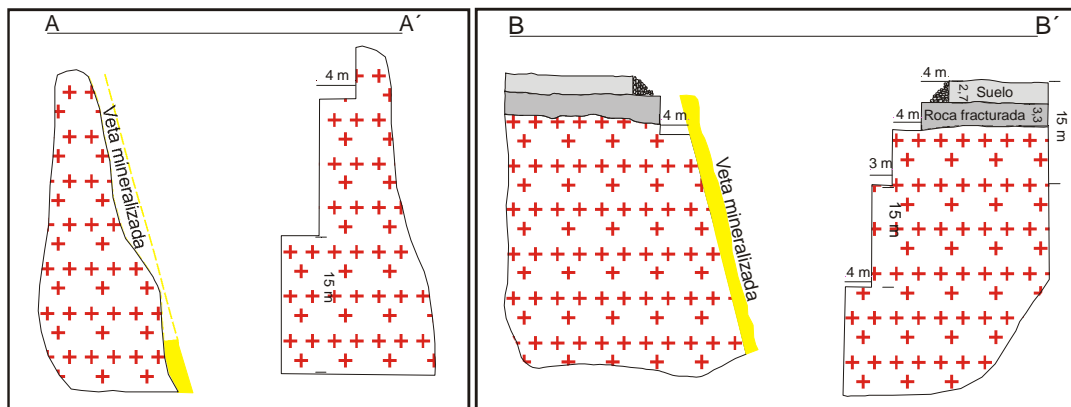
Secciones transversales de apertura de cantera a tajo abierto en Mahoma (fuente Bond International Inc. / Plan de desarrollo).
